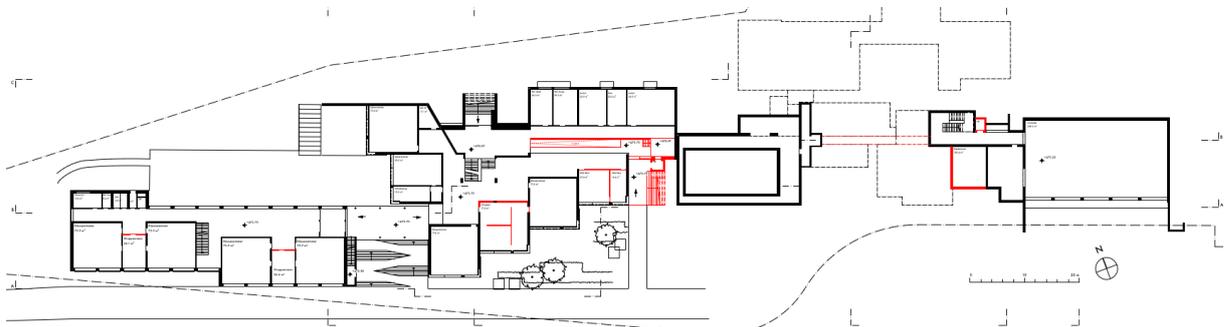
Ebene 01 Grundriss Obergeschoss Primar / Kindergarten
